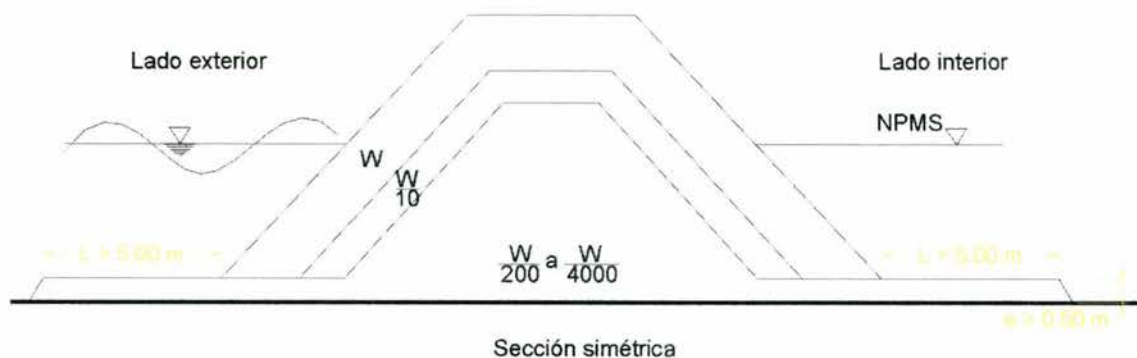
Sección transversal para el morro de una estructura formada con enrocamiento o elementos prefabricados
